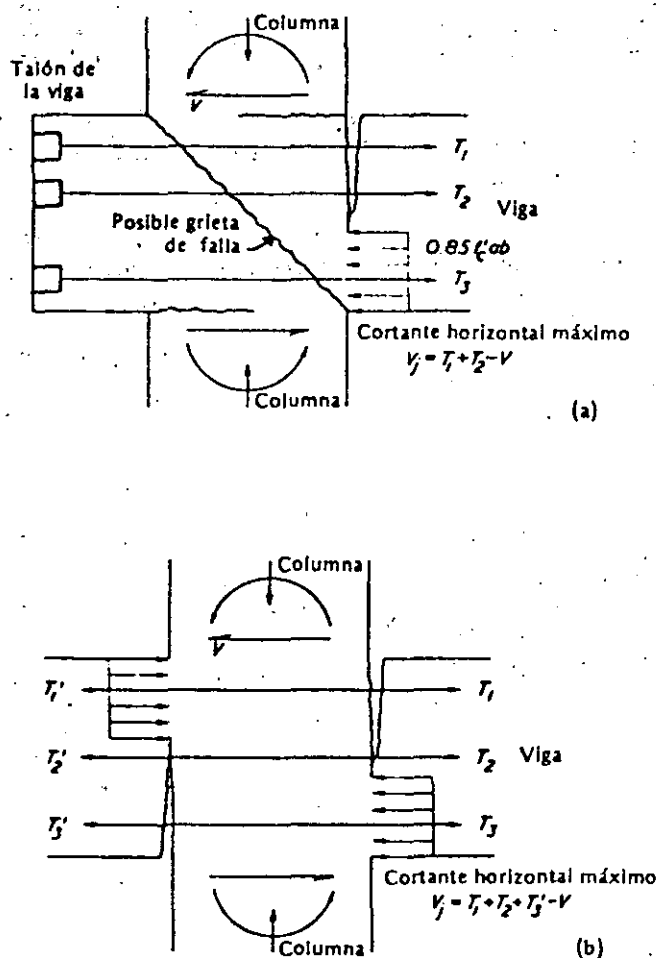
Juntas viga-columna de concreto presfuerzoado. a) Columna exterior, b) columna interior.
